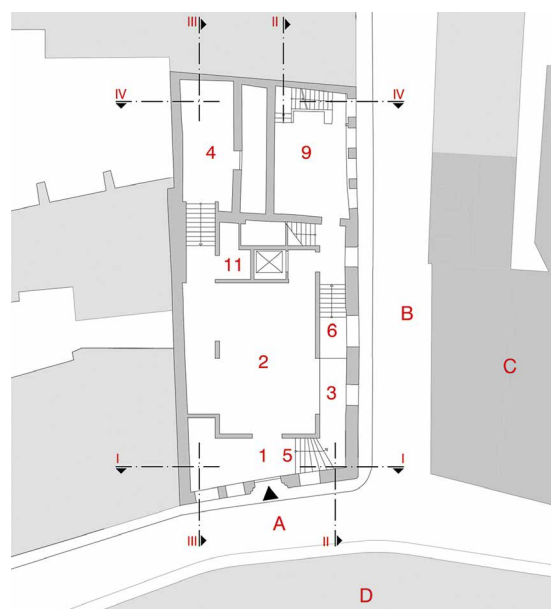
Museum; Grundriss Erdgeschoss [© Konermann Siegmund Architekten BDA Stadtplaner]
